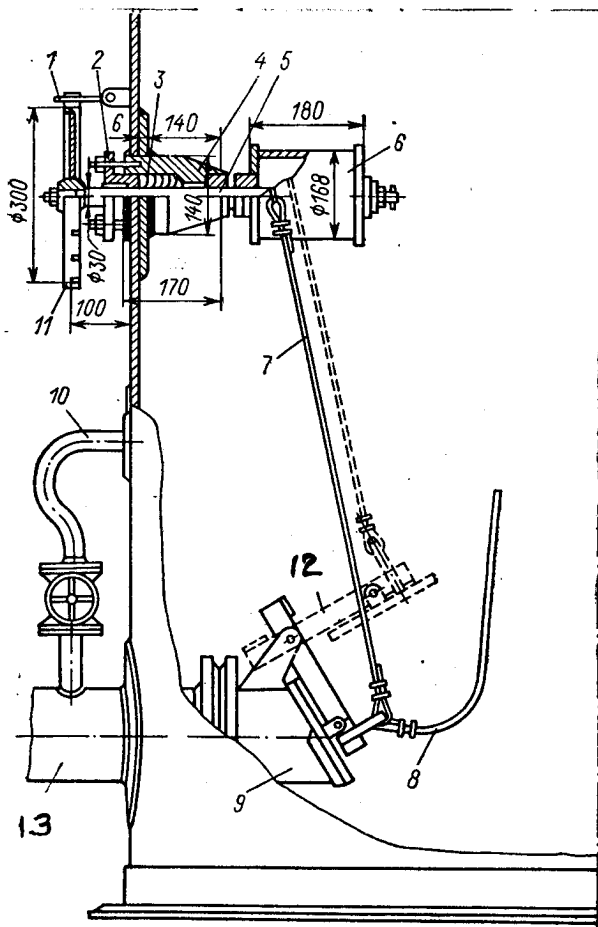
Установка ГВПС-2000 на резервуарі:
